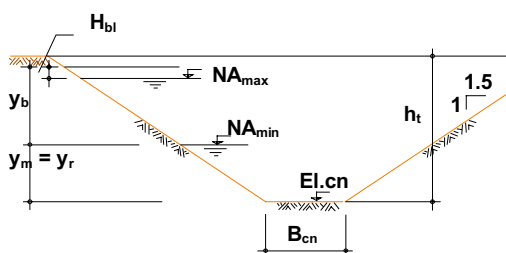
Seção transversal típica de canal de adução em solo (caso 3).
